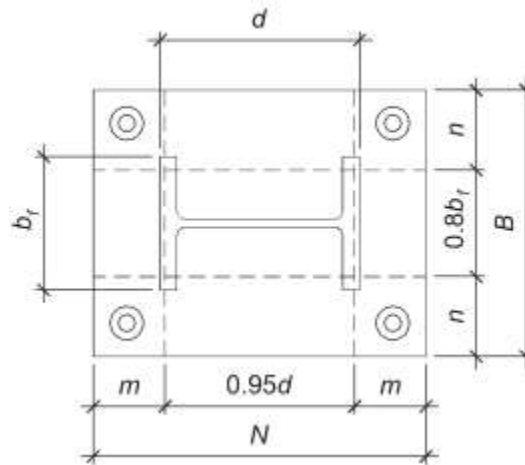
Dimensiones vista en planta de placa de anclaje (AISC, Base Plate and Anchor Rod Design, 2006)
